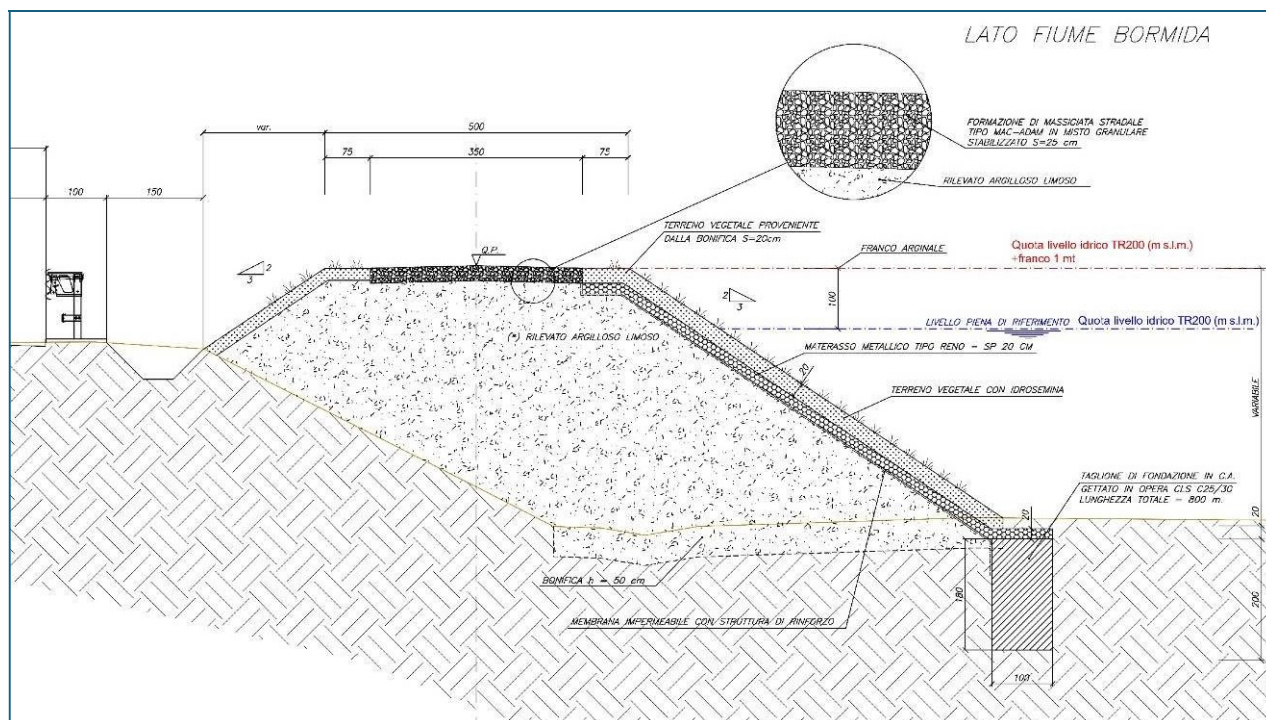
Argine sinistro, opera 5 - sezione trasversale tratto sezione 1 - sezione 12
